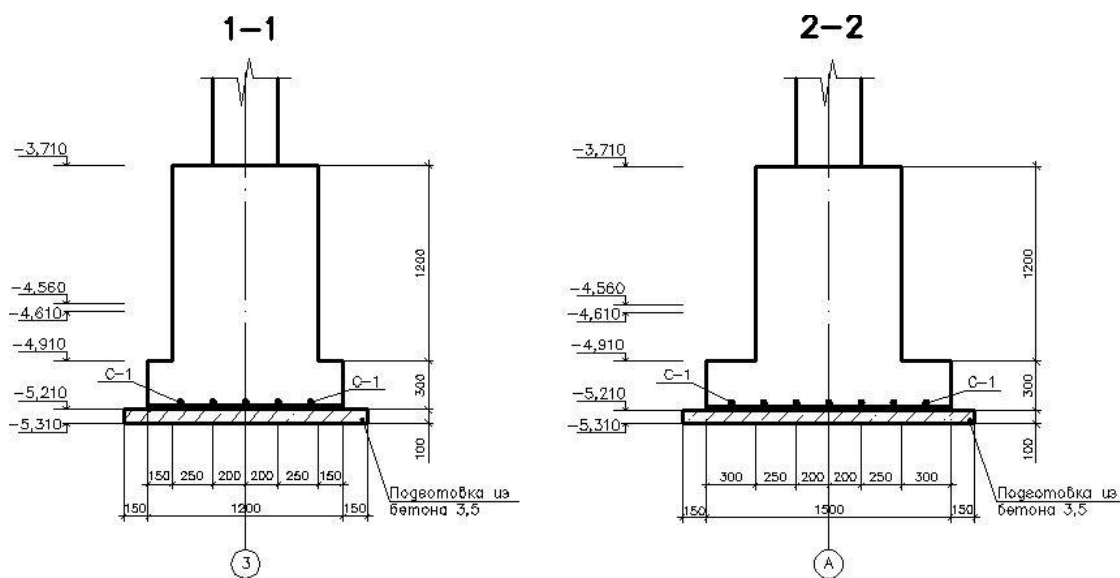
Схема армирования плитной части фундамента
